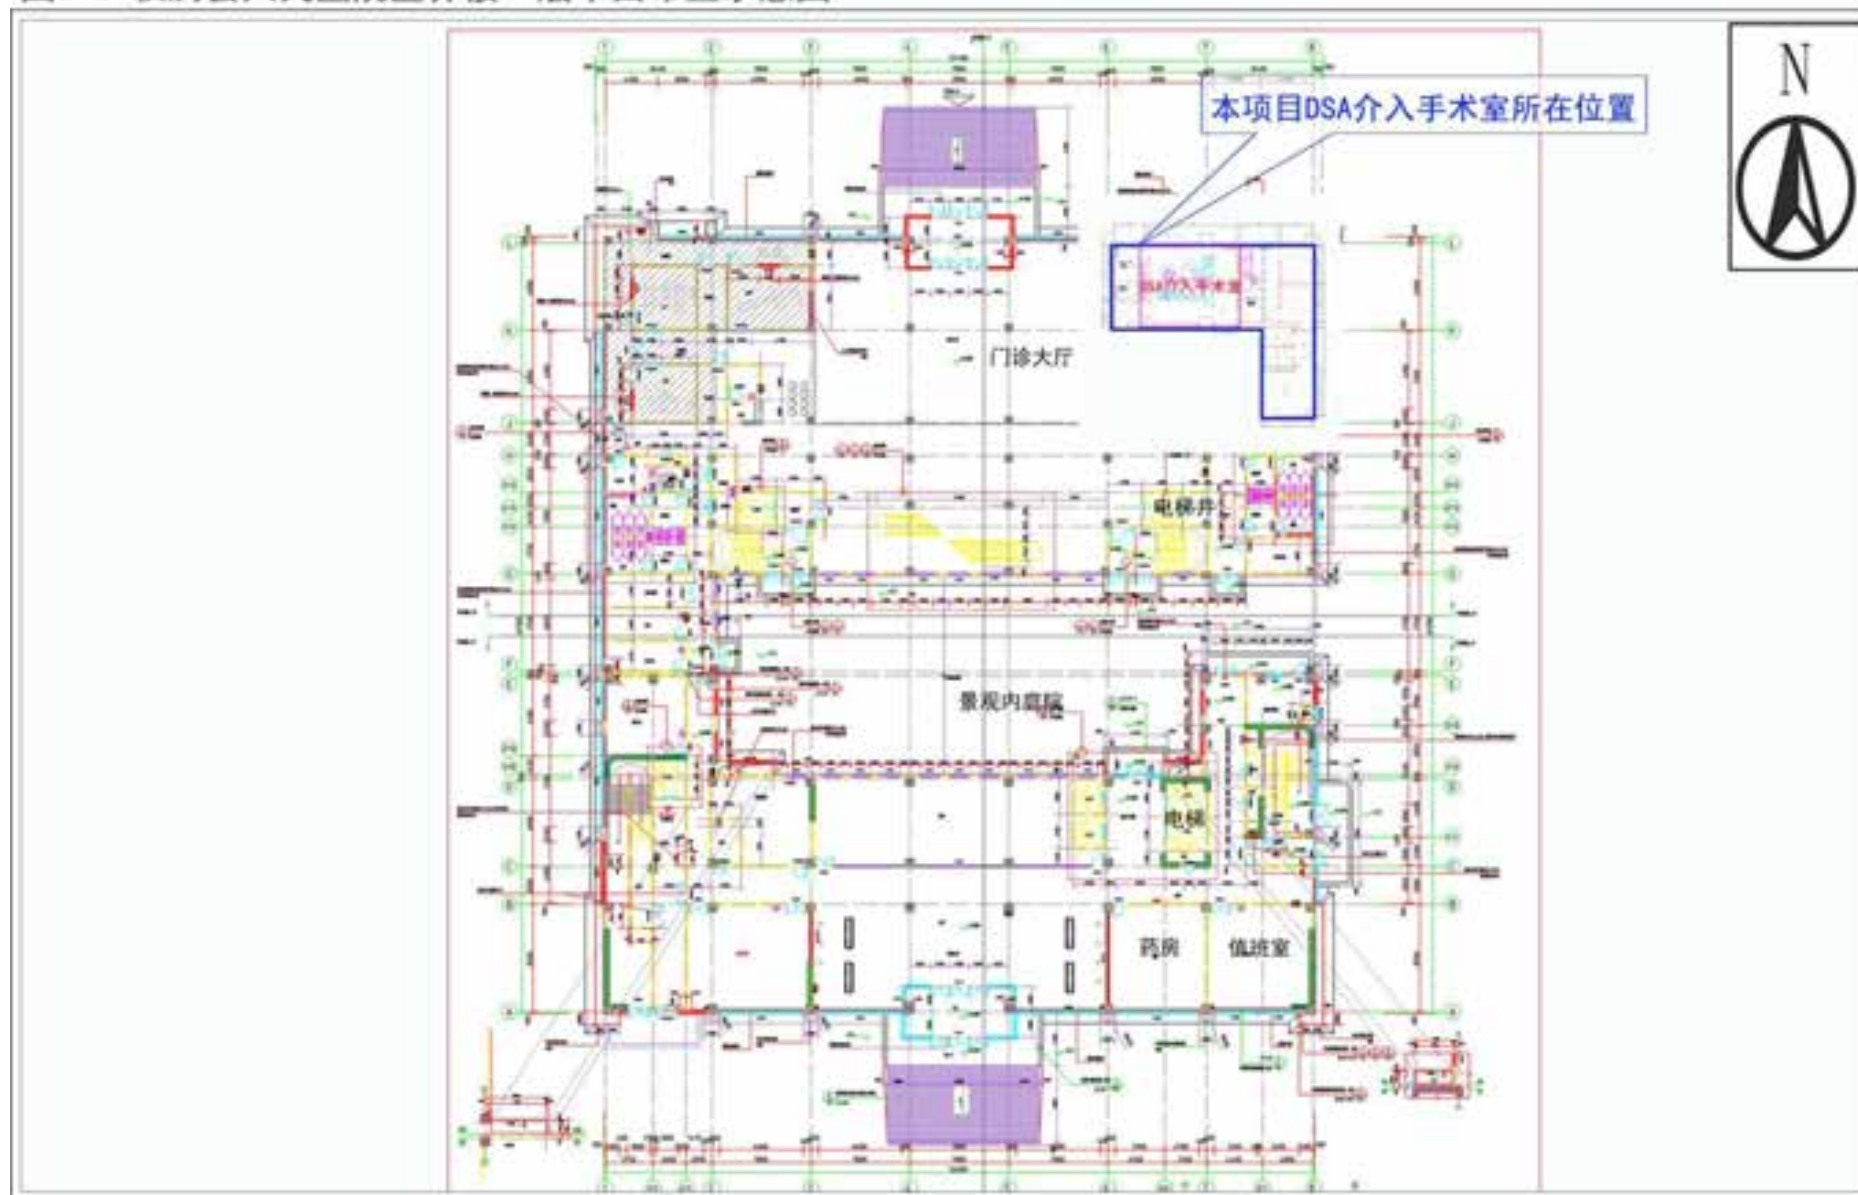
临朐县人民医院医养楼二层平面布置示意图（局部）
